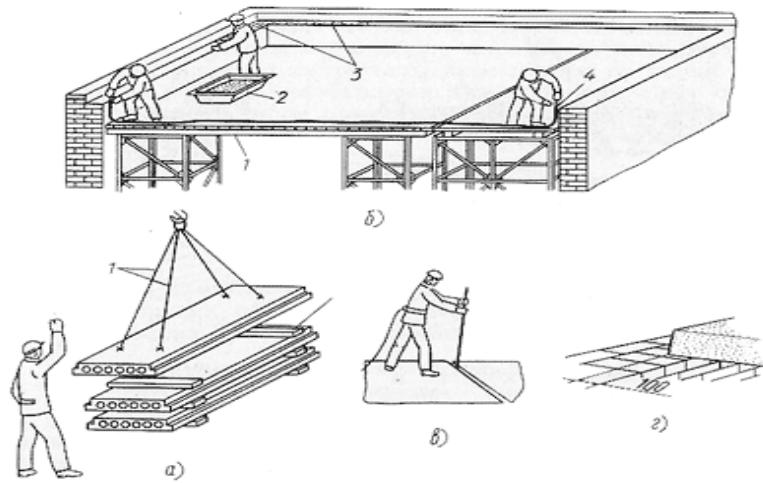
Підготовка опорної поверхні для плит міжповерхового перекриття:
